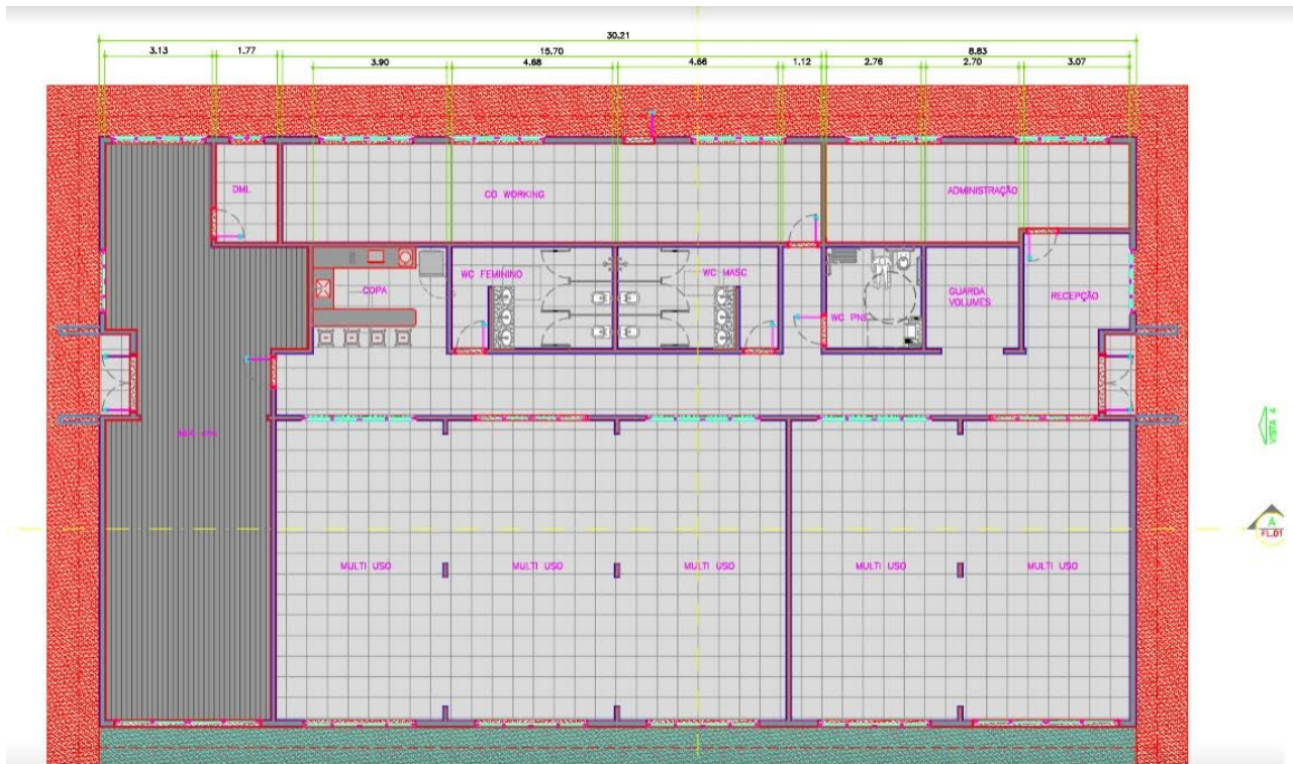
Planta Baixa - Área de 616 metros quadrados.
